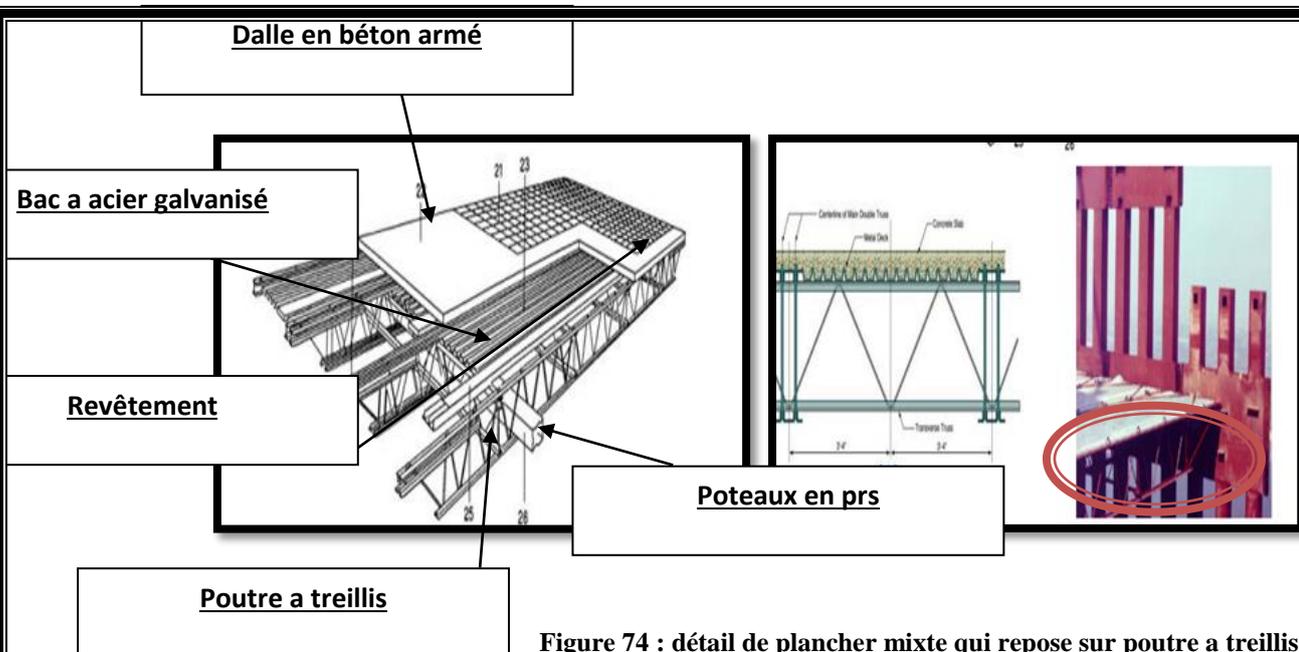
détail de plancher mixte qui repose sur poutre a treillis
